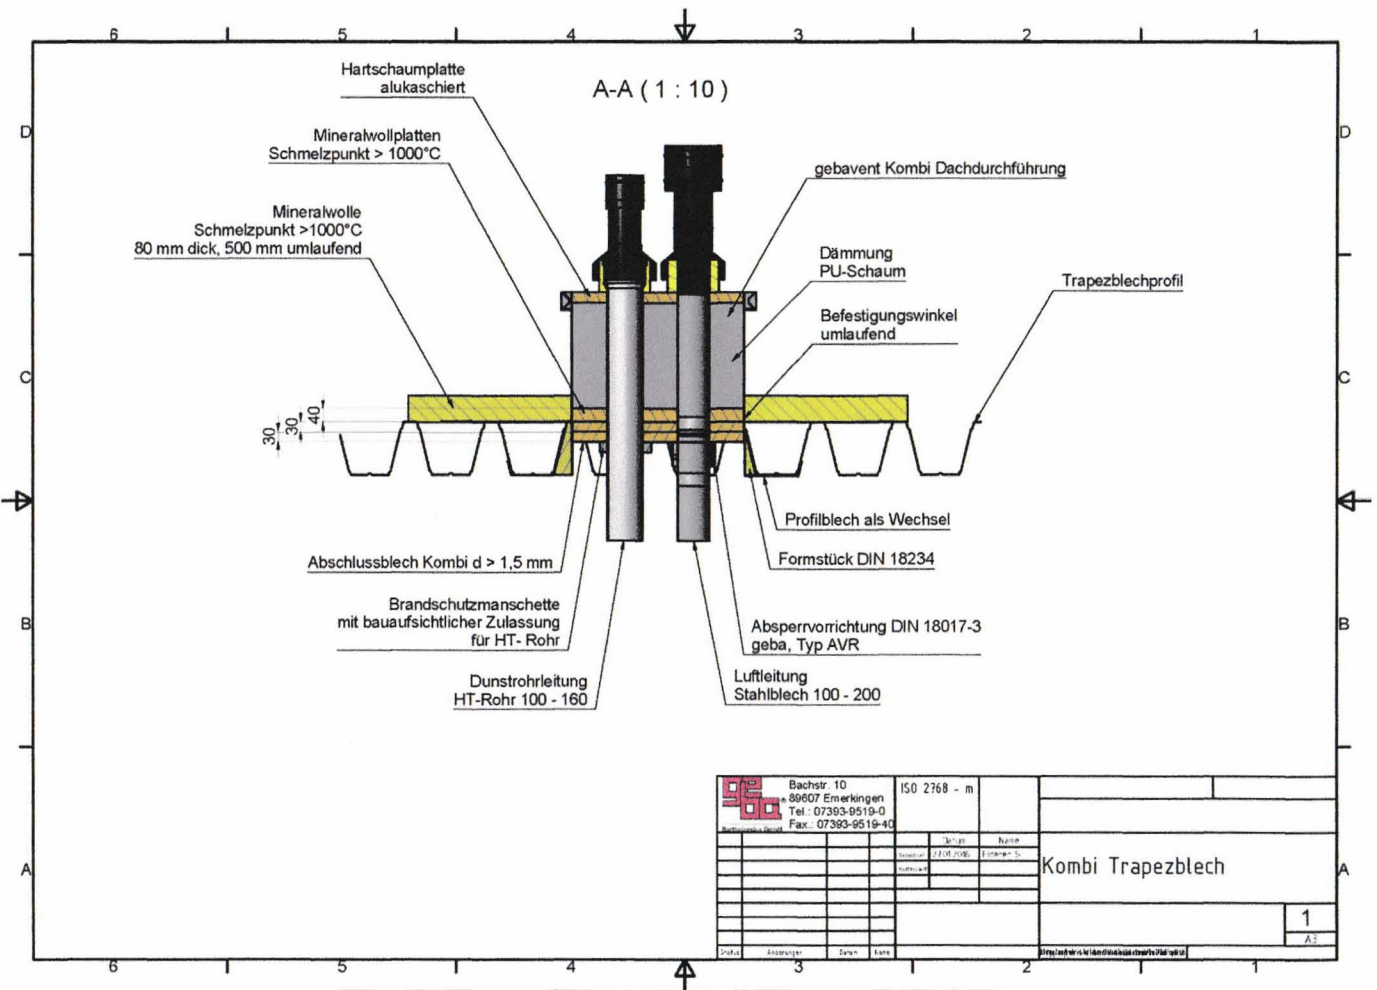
Gebavent Kombi für den Einbau in Dächer nach DIN 18234, mit tragender Dachschale aus profilierten flächigen Baustoffen (z.B. Stahltrapezprofilen)
